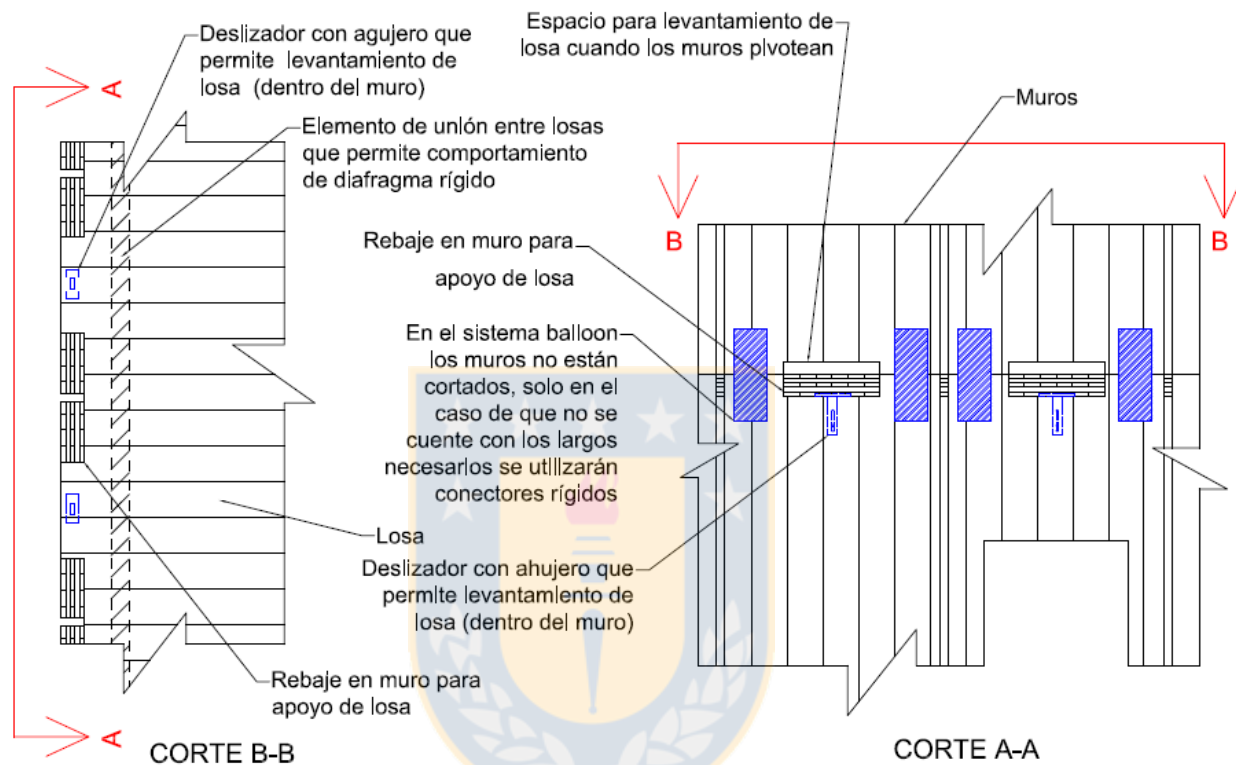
Unión propuesta para apoyo de losa sobre muros
